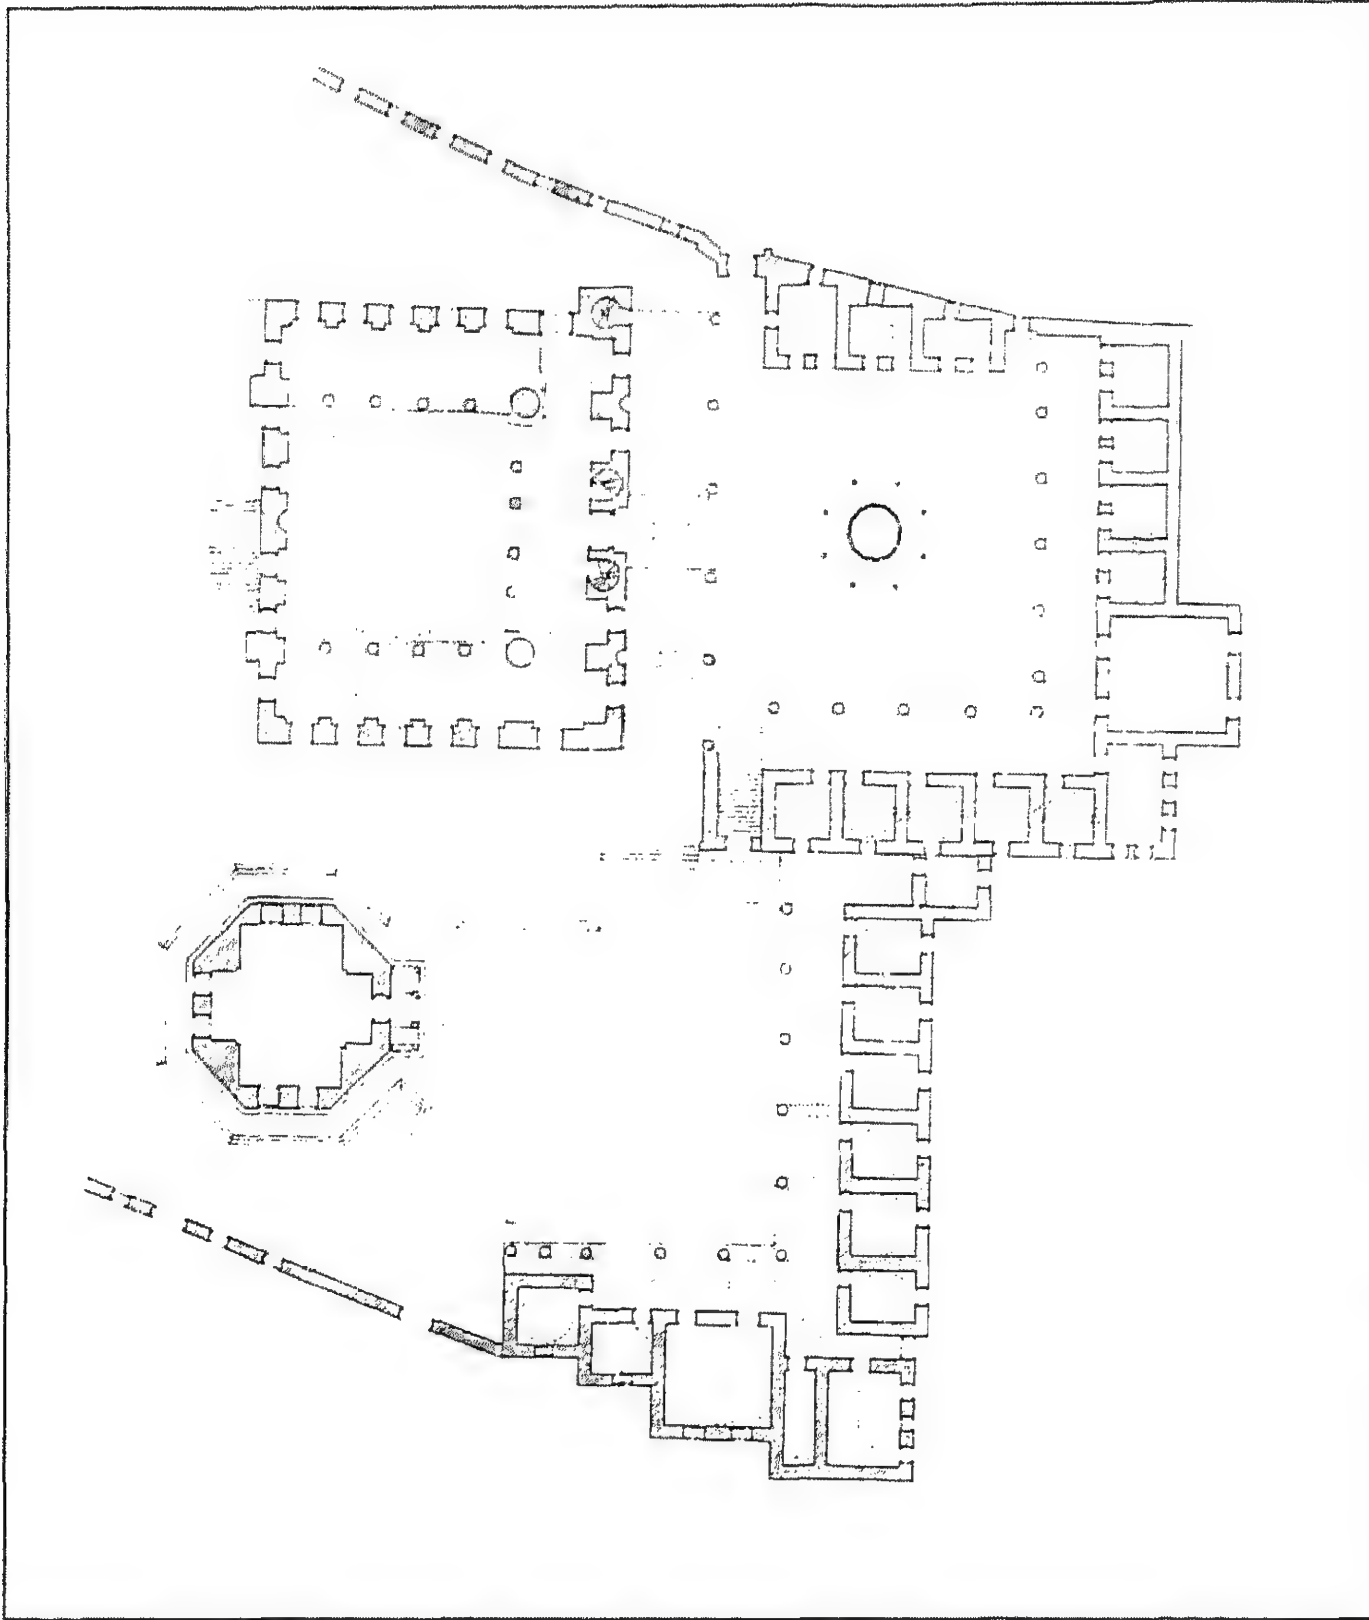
مسقط أفقي لمدرسة قاي اغاسى في اماسيا (عن : جابريل).
